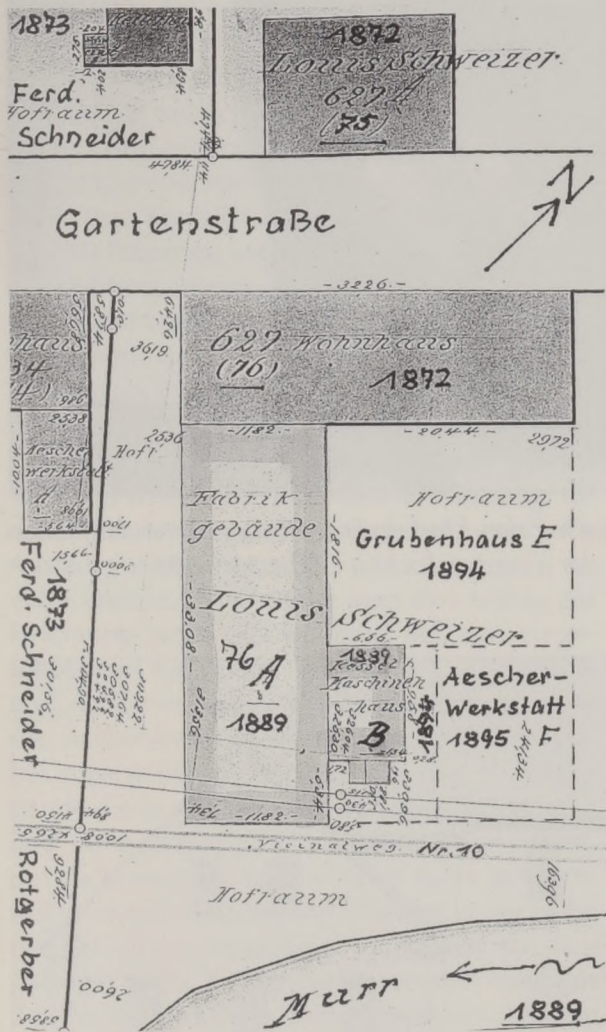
Lageplan mit dem Gebäudebestand von 1889 und den geplanten Bauten bis 1895.
